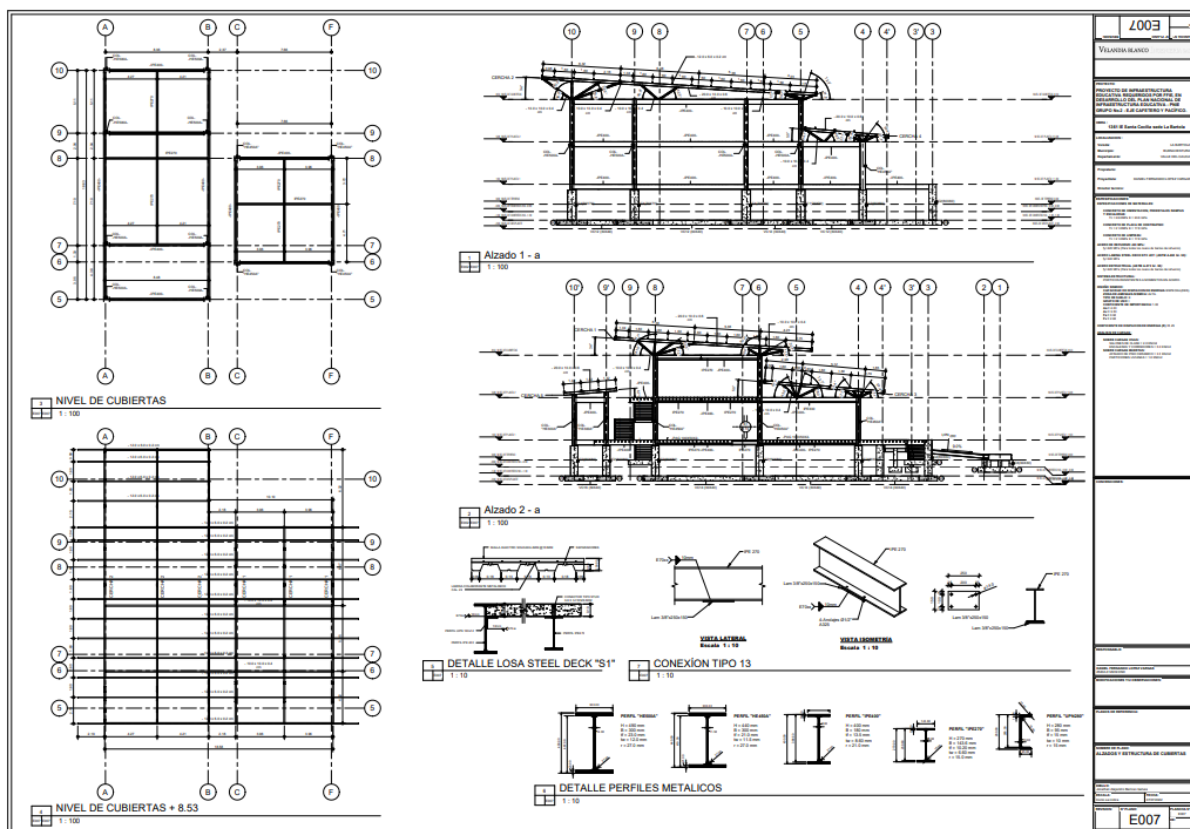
Planos de alzados, plantas de cubiertas y detalles de secciones. (fuente: propia).
